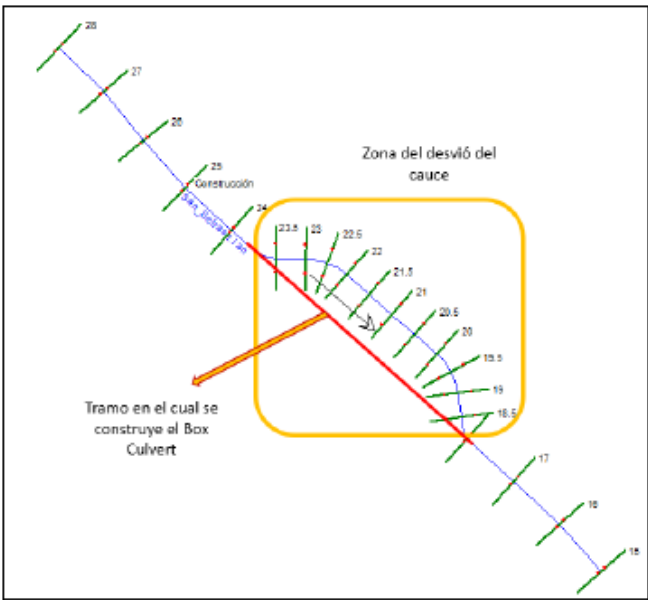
Geometría de canal provisional durante proceso constructivo de los Box Culvert N°1, 2, 3 y 4
